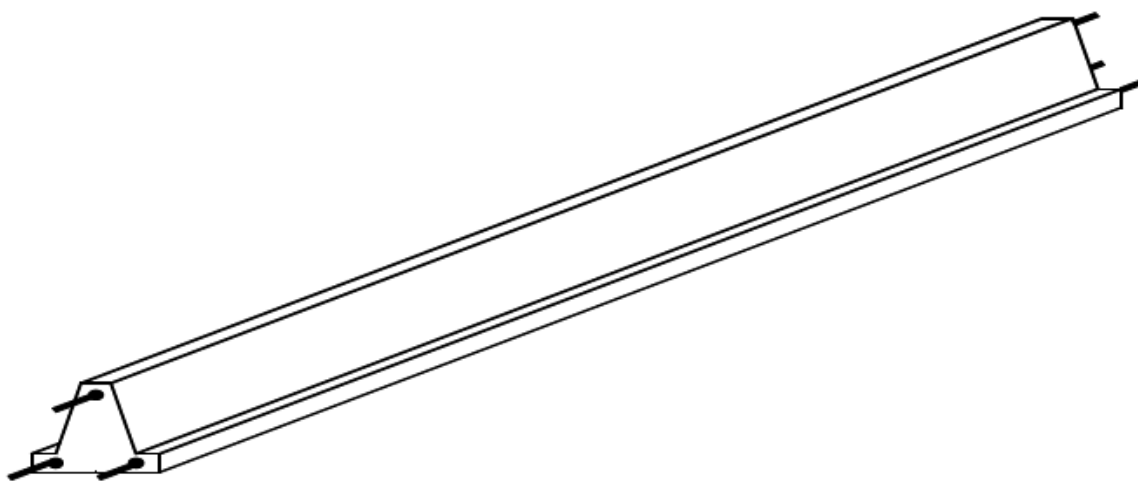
Esquema de vigota pré-moldada em concreto armado.
